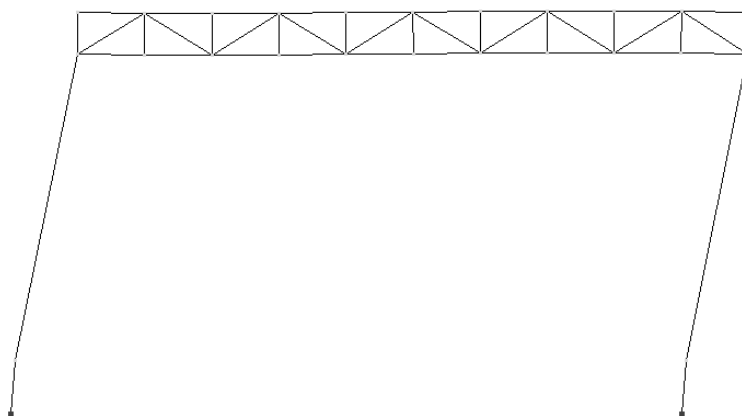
Деформированная схема от ветровой нагрузки (ветер слева)
